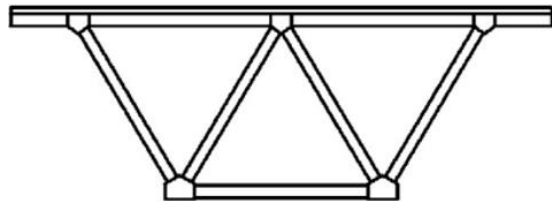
Поперечні перерізи ферми із їздою зверху:
